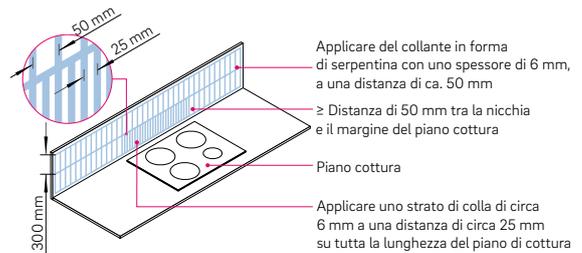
Fissaggio di RAUVISIO crystal alla parete posteriore
